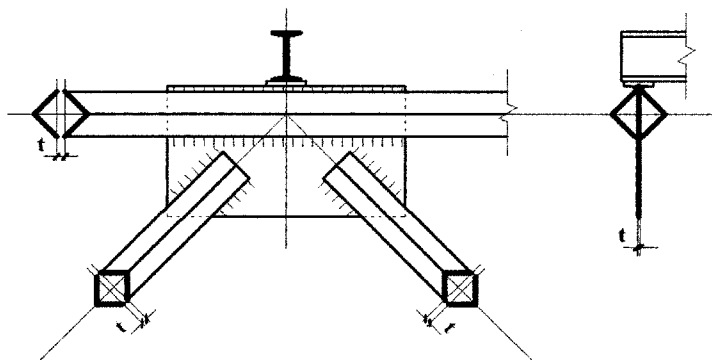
Стропильная ферма, сваренная из равнополочных уголков, поставленных под углом 45°
